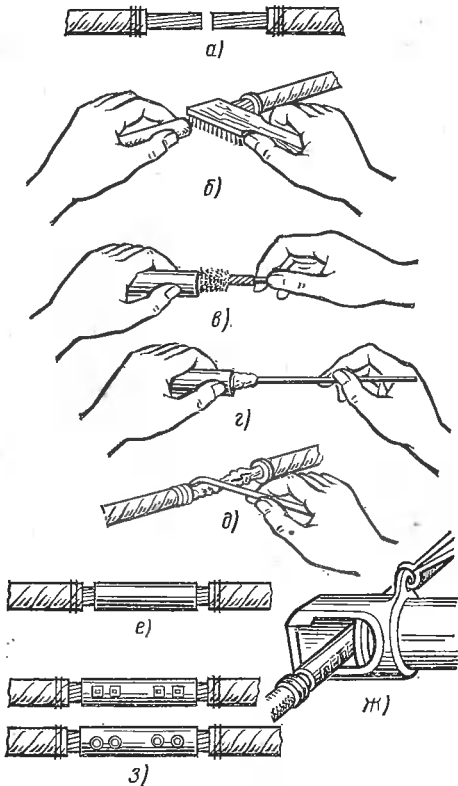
Опрессовка алюминиевых жил сечением 16—240 мм²:
